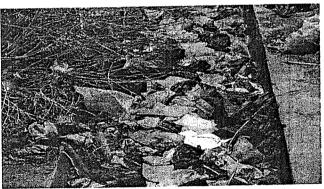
Etat d'un caniveau qui nécessite d'être curer
